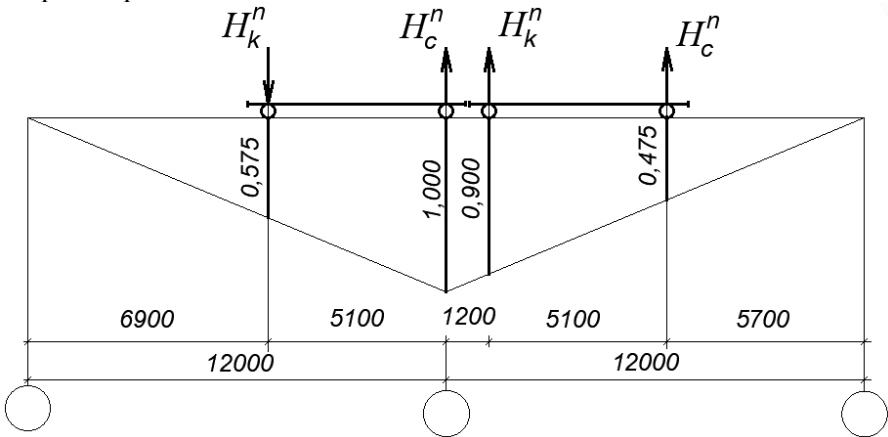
Схема для визначення горизонтальних кранових бічних навантажень від двох зближених кранів на середню опору за другим рекомендованим варіантом для правої сторони крана
